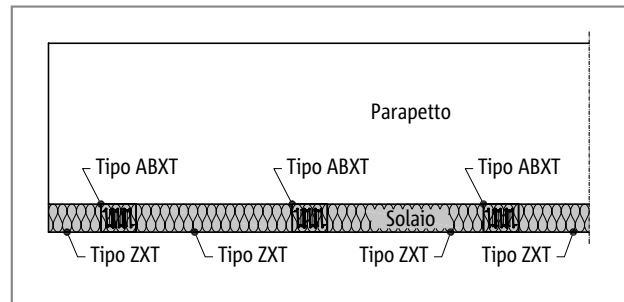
Schöck Isokorb® tipo ABXT - disposizione orizzontale, parapetto anteposto
